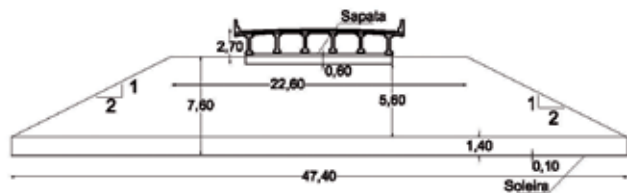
Vista frontal esquemática do muro portante instrumentado
